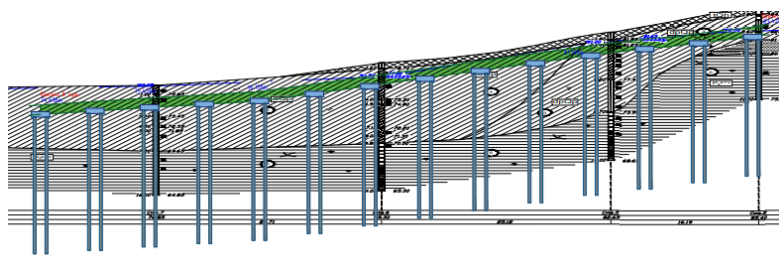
Вертикальная привязка буринъекционных свай ЭРТ и монолитных железобетонных ростверков по напорный трубопровод $d=1020,0$ мм.
